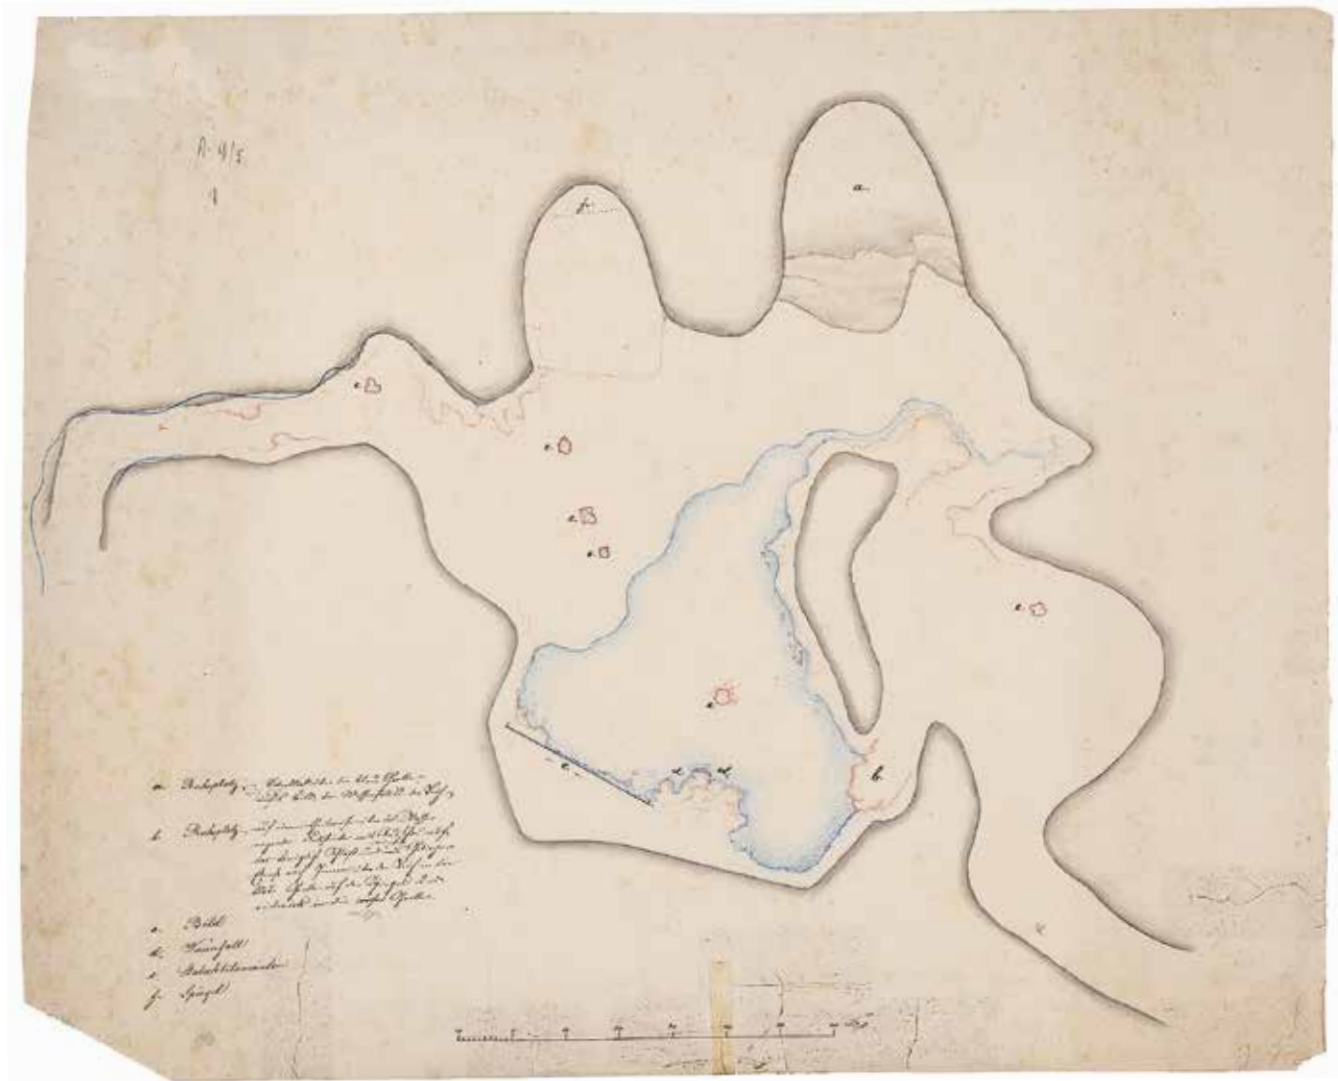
Grundriss der Venusgrotte, ca. 1876, BSV, Plansammlung der Gartenabteilung, Inv.-Nr. LI-01-05-6
